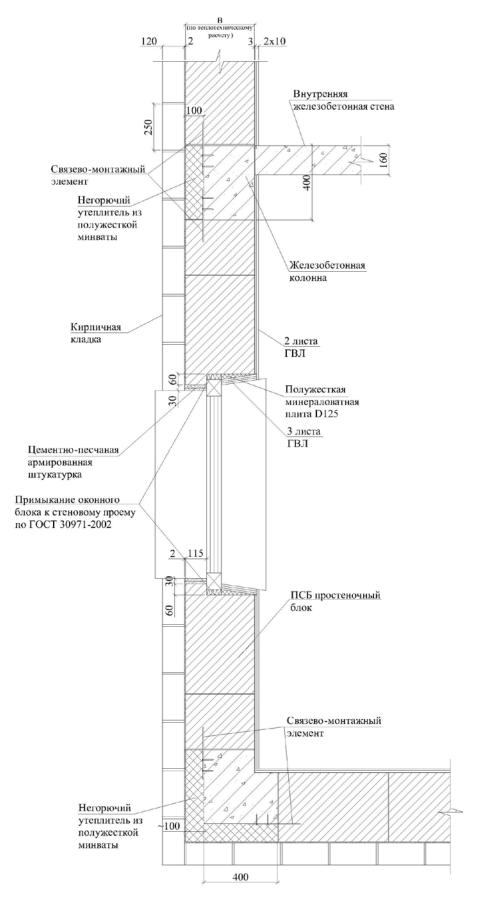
Ненесущая стена из ПСБ блоков для зданий с несущими железобетонными колоннами и кирпичной облицовкой фасада. Горизонтальный разрез
